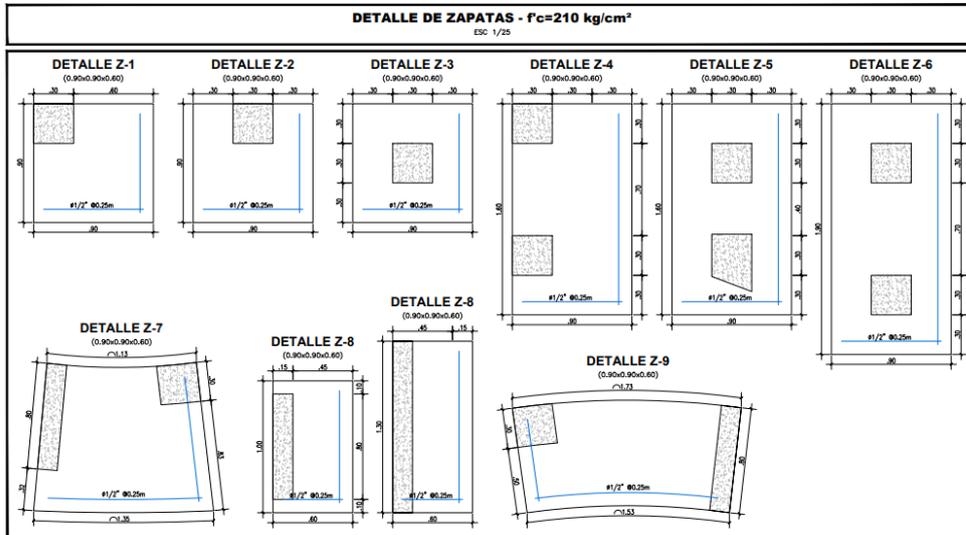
Detalle de Zapatas Aisladas y Combinadas
